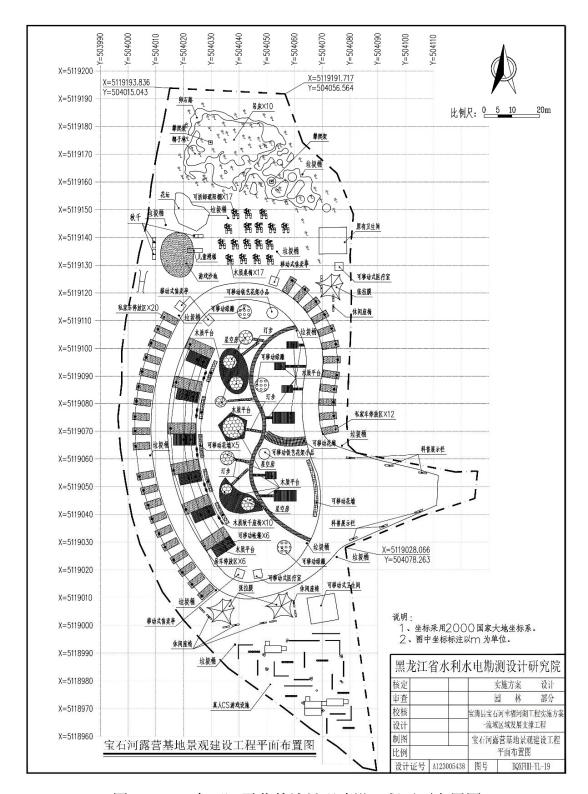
宝石河露营基地景观建设工程平面布置图
